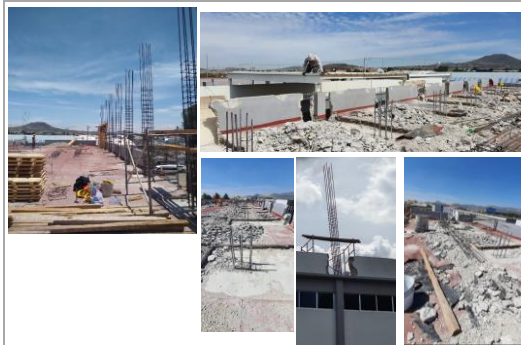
Demoliciones en losa existente para anclaje de armado de columnas para desplante de 2do nivel.
